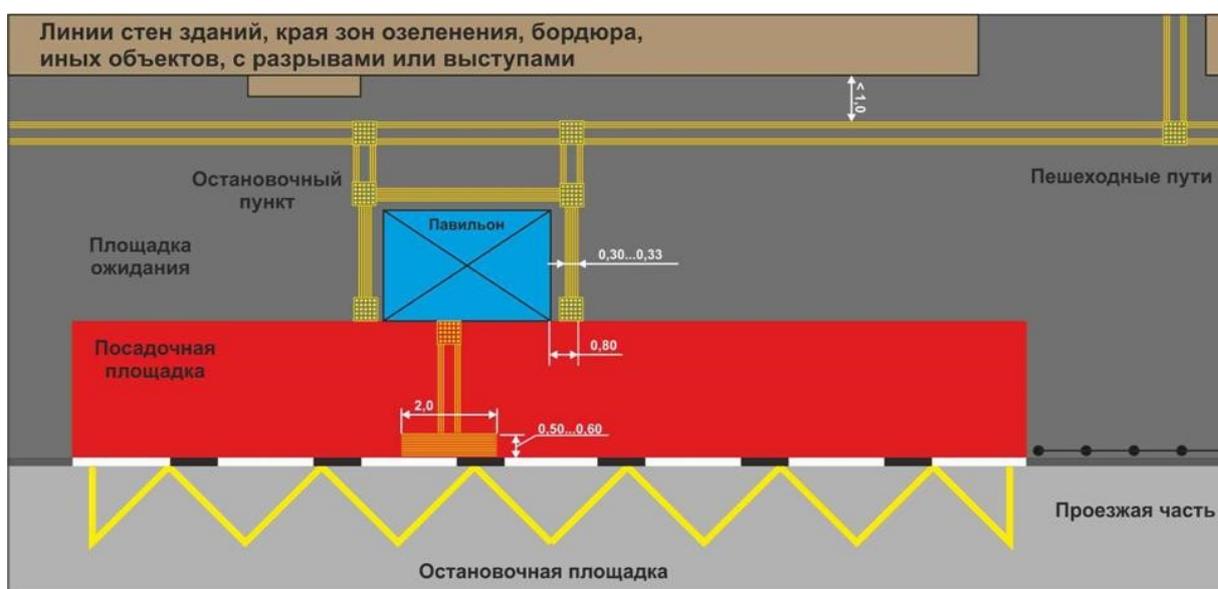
Типовая схема укладки тактильных плит на посадочных площадках остановок общественного транспорта
